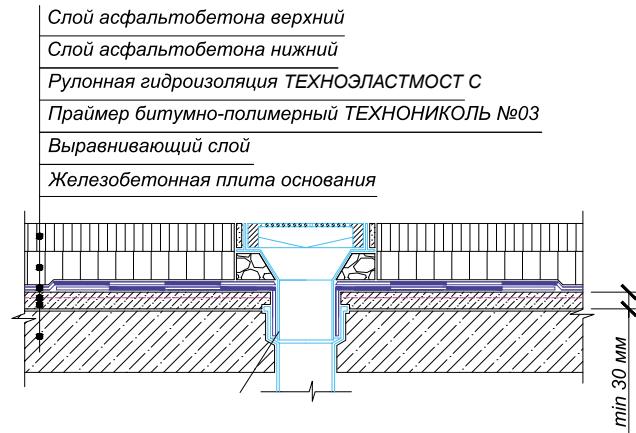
Сопряжение гидроизоляции с водоотводной трубкой.
